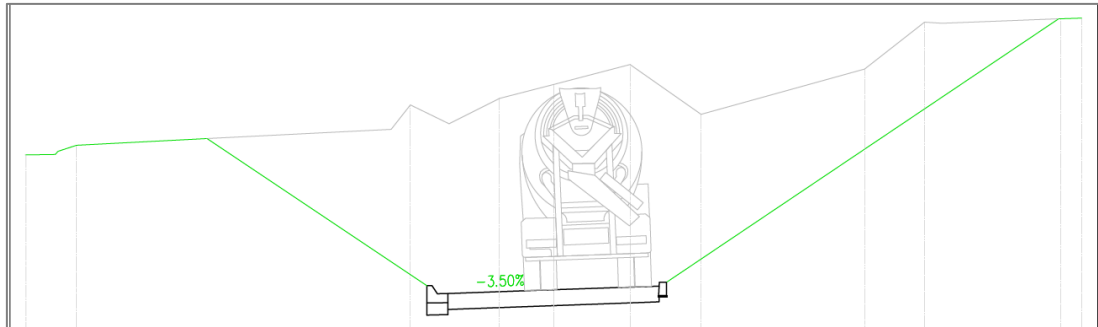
Estratto della sezione tipo del primo tratto, in trincea rispetto al terreno esistente
